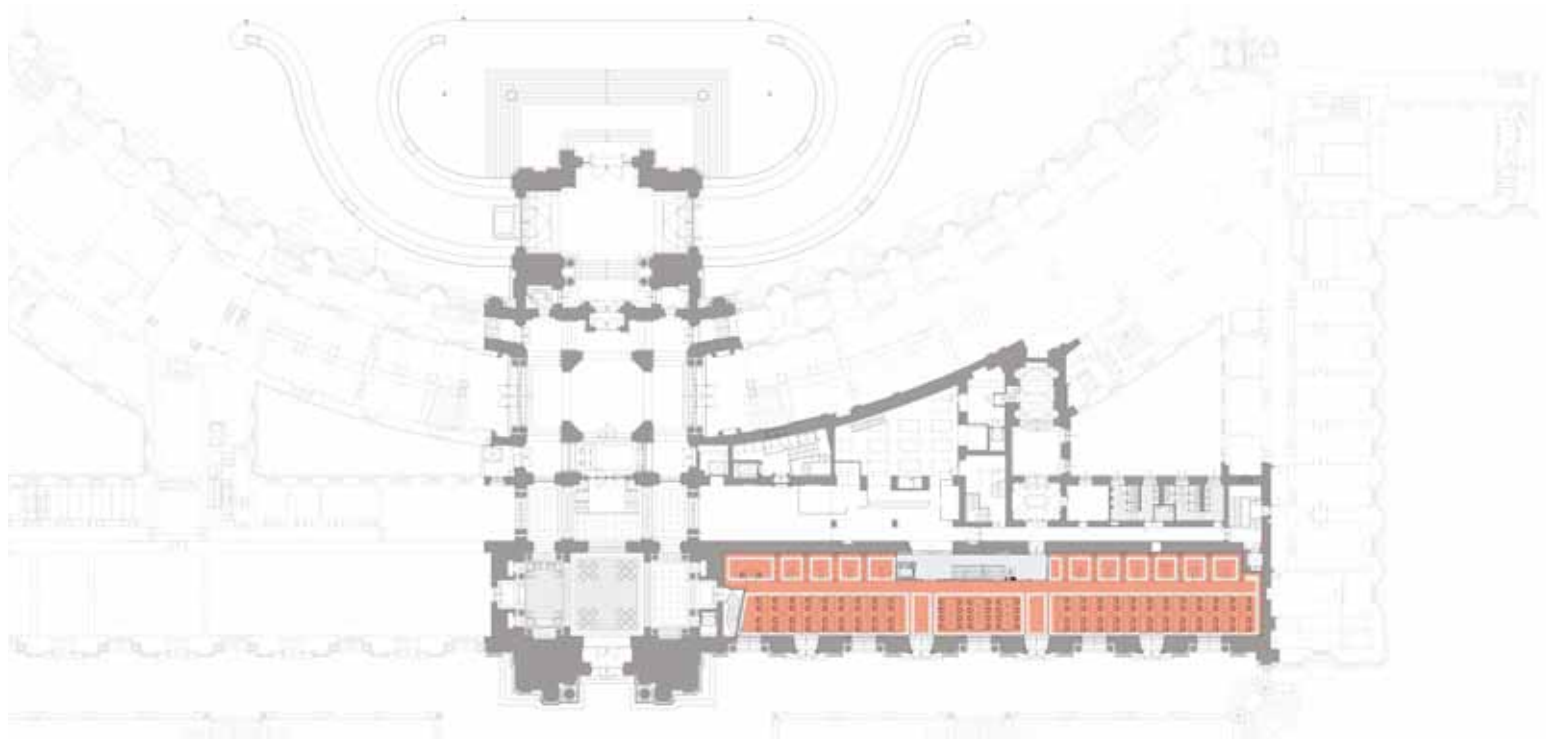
Grundriss Lesesaal Nationalbibliothek
